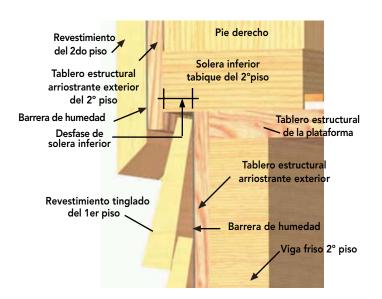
13: Detalle de solución constructiva para el encuentro del revestimiento entre dos niveles, desfasando la solera inferior de los tabiques perimetrales del segundo piso. Corte y vista en perspectiva del muro exterior con el revestimiento instalado.
